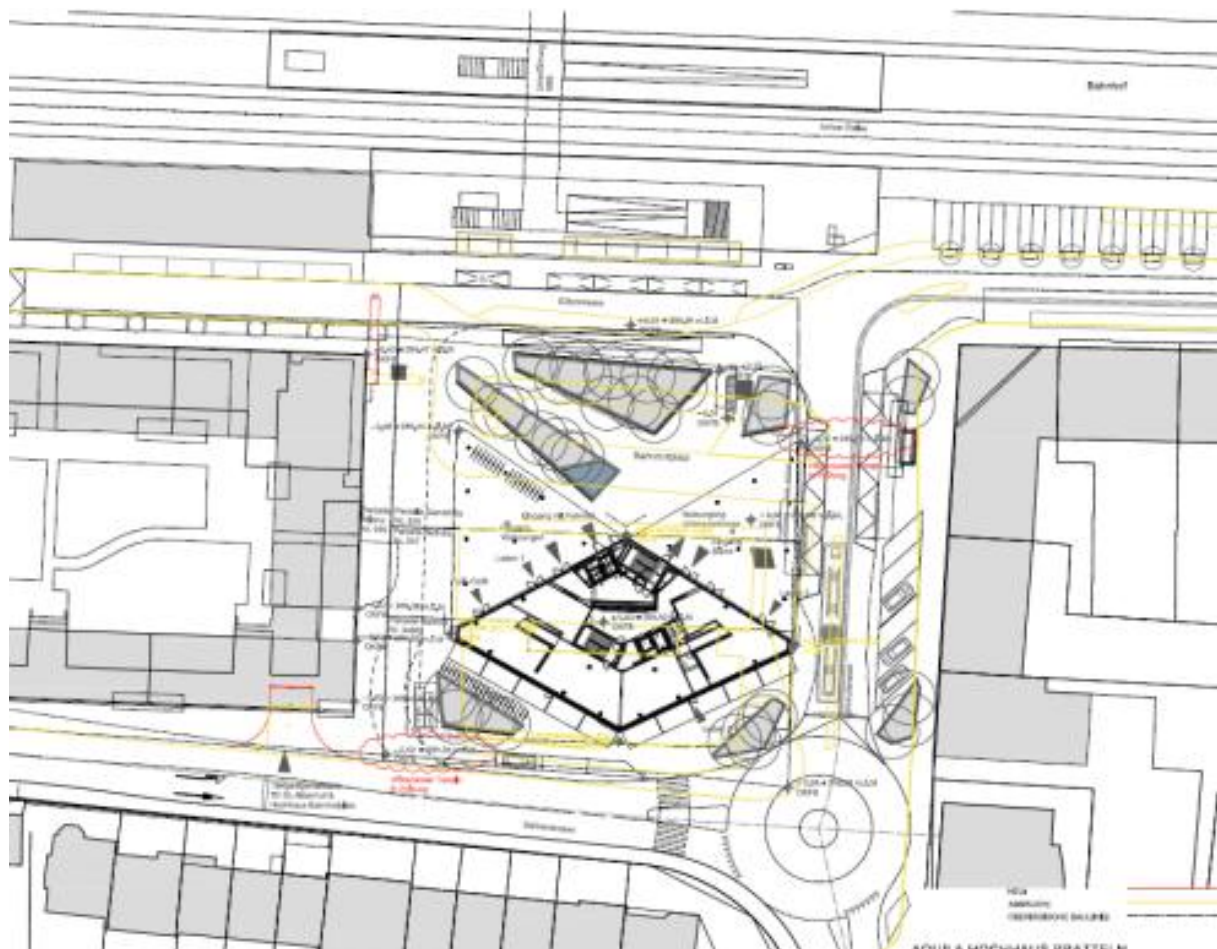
Situationsplan AQUILA mit Bahnhof Pratteln
